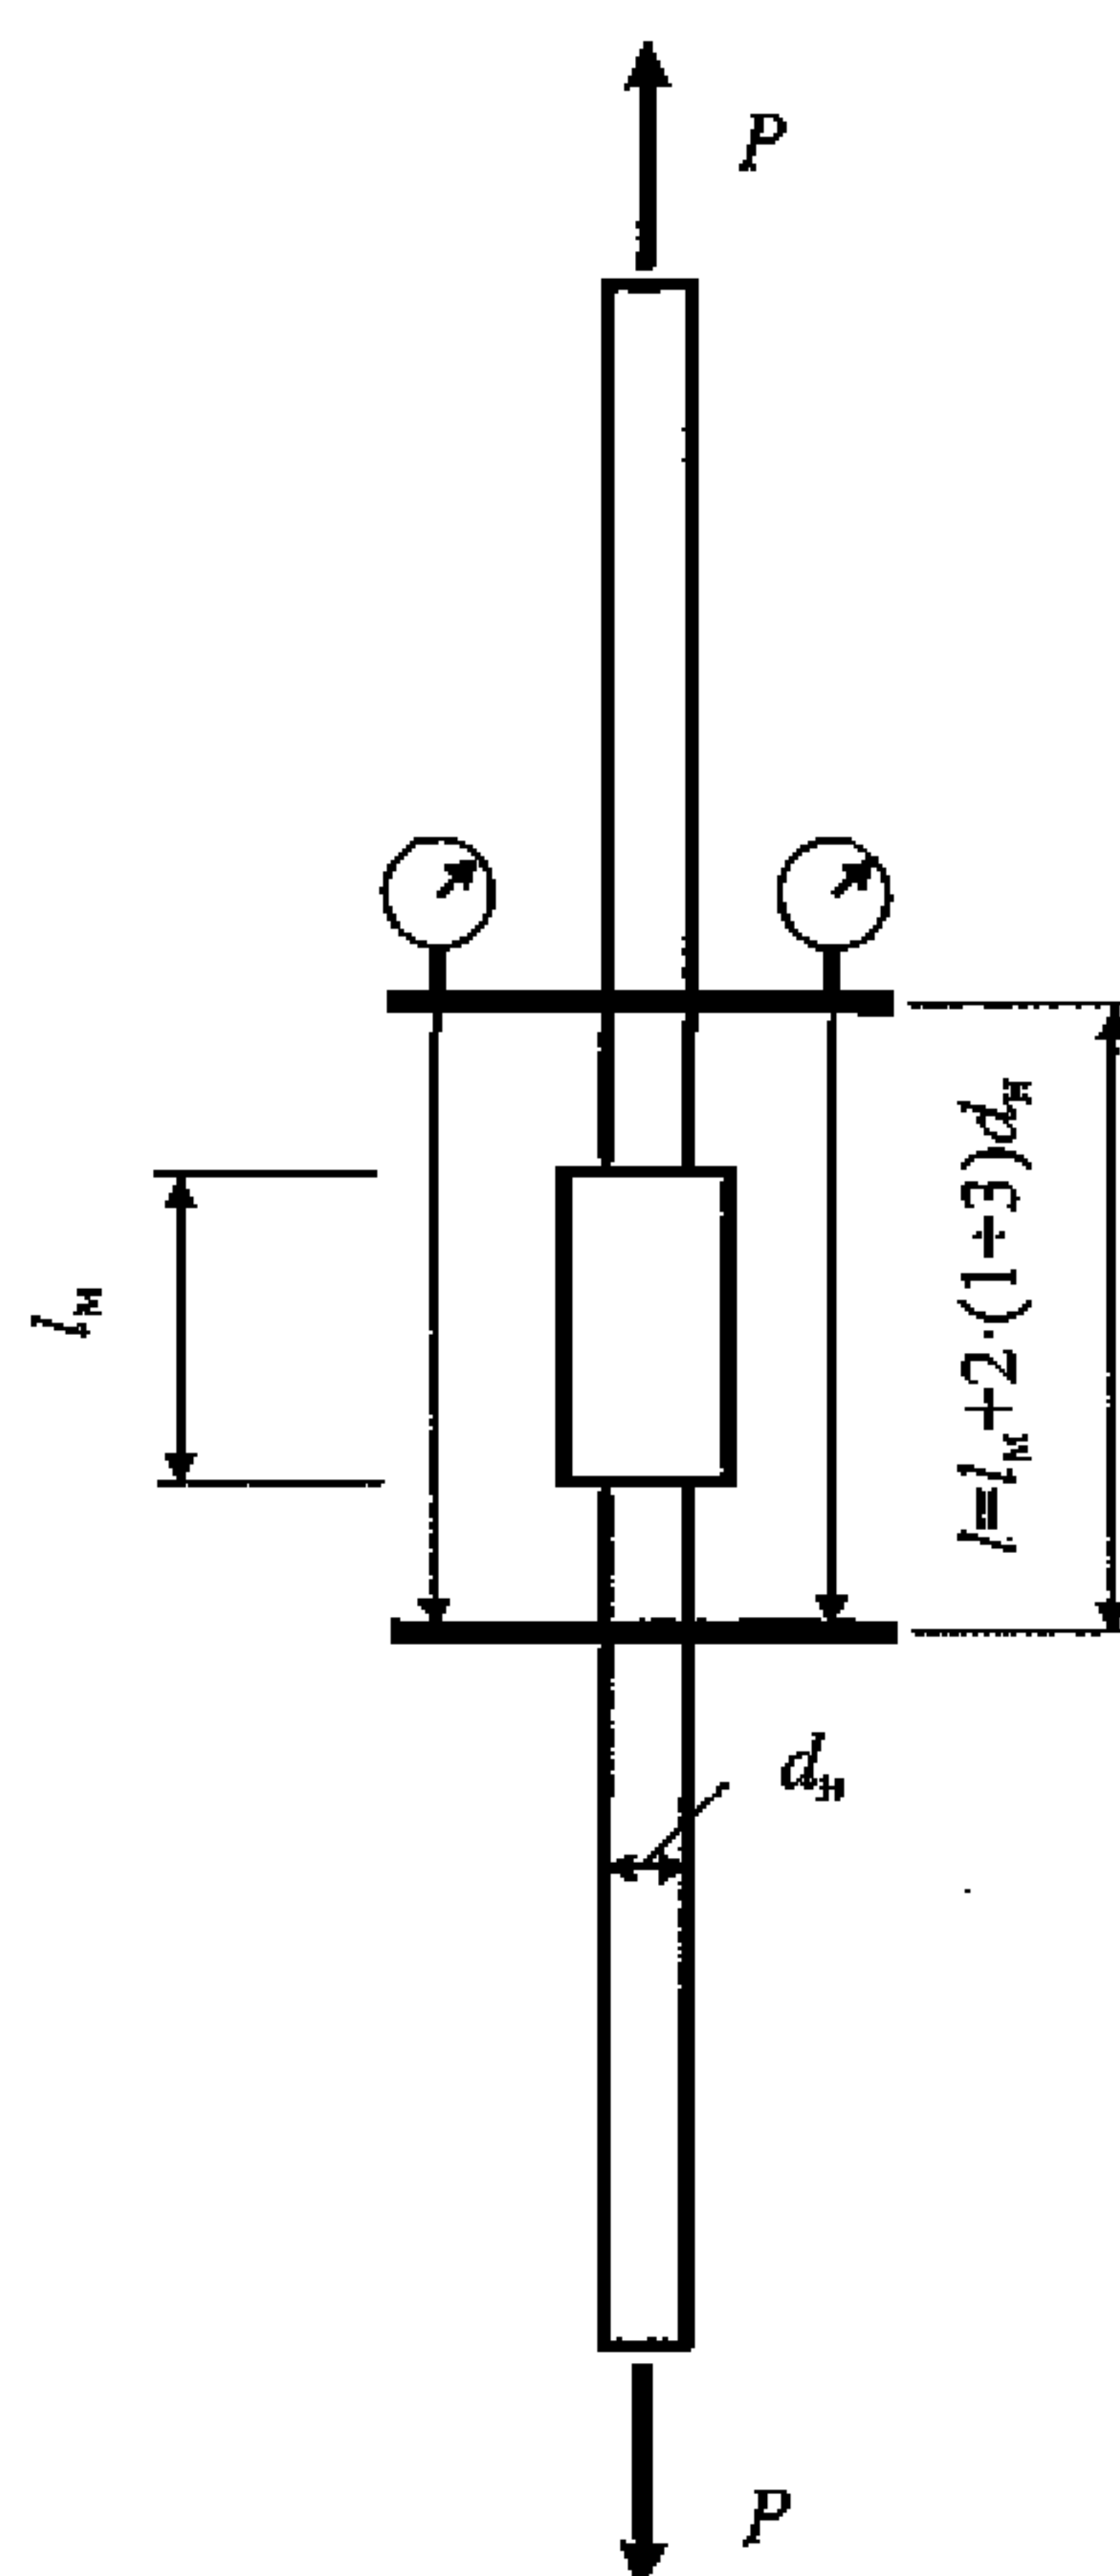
Схема испытаний образца механического соединения на растяжение
